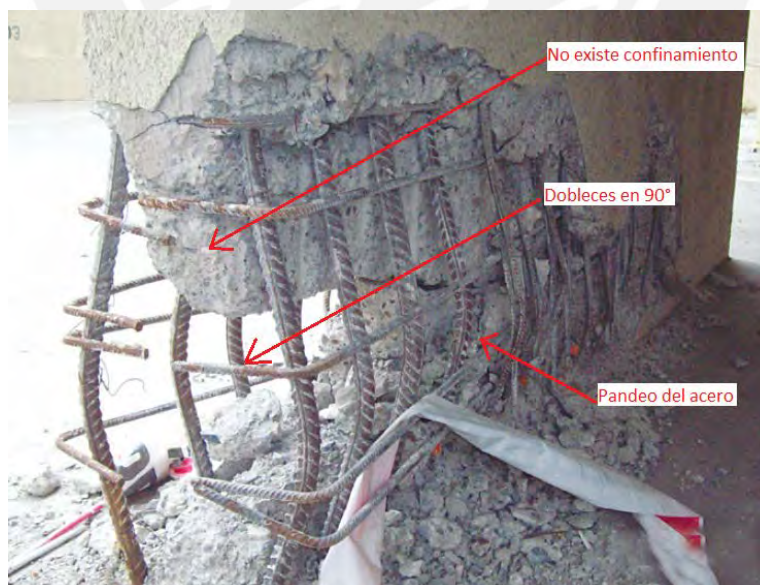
Pandeo del acero debido al pobre detallamiento en la sección del muro.
